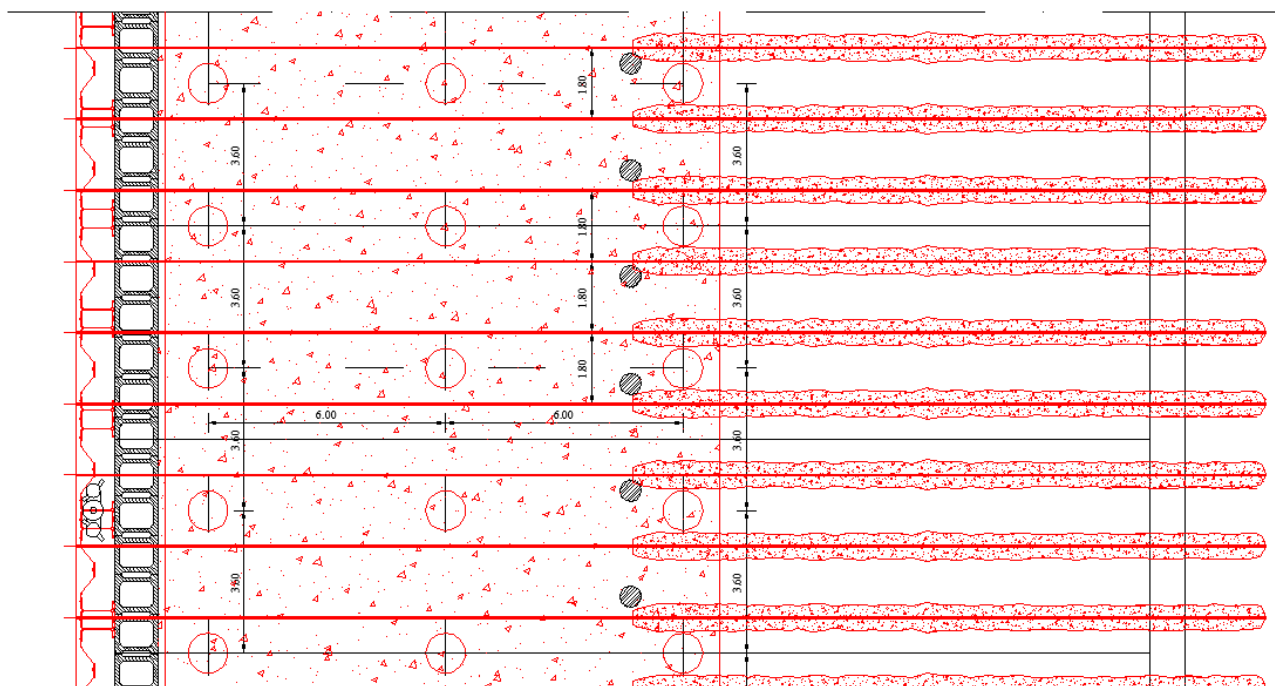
Stralcio planimetrico del banchinamento (in rosso le nuove opere)
